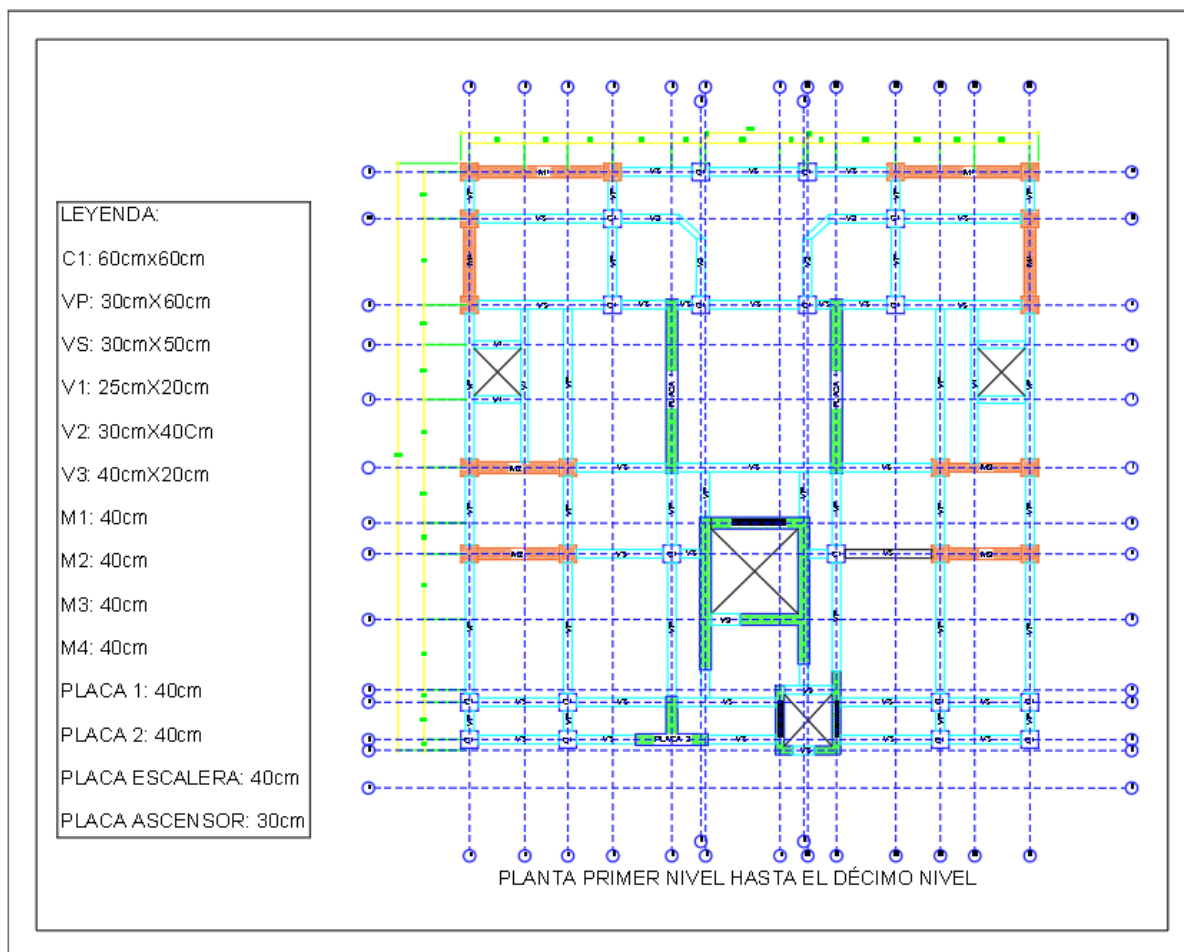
Plano de Estructuras Planta 1er piso - 10mo piso.
